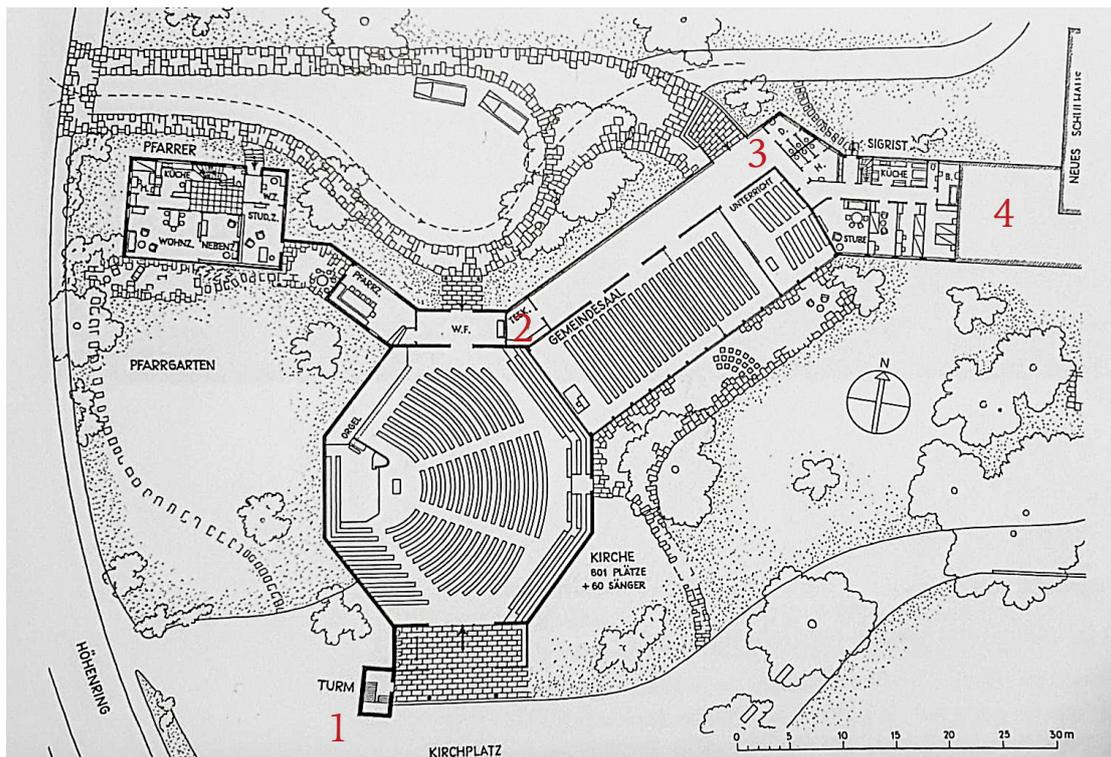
1. Preis A. H. Steiner vom Wettbewerb 1938 - Grundriss Kirche
